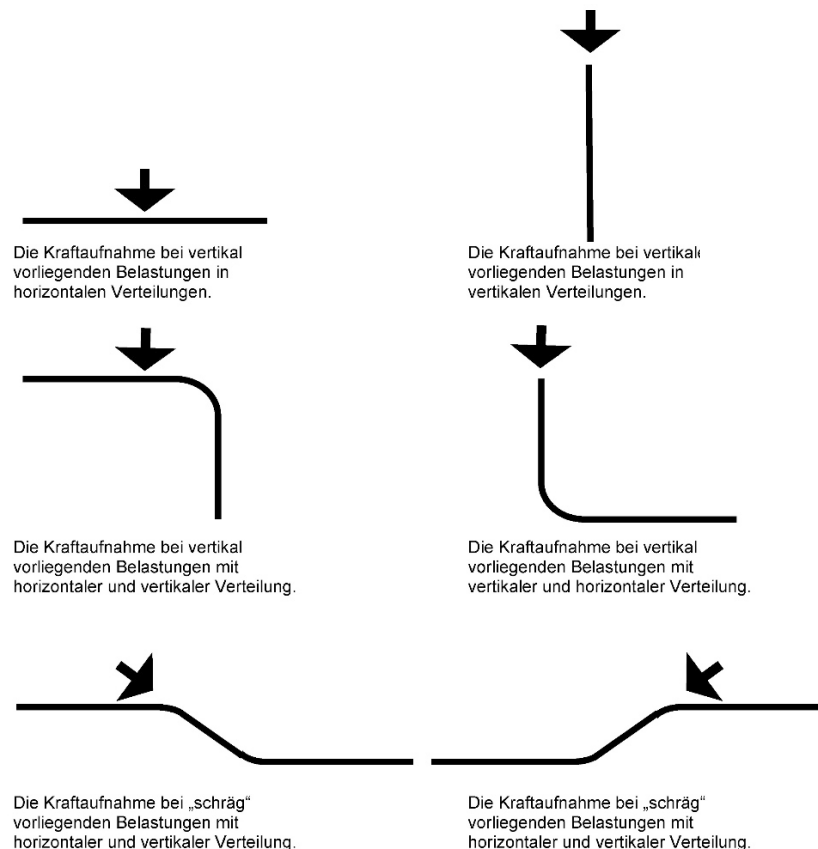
Die Mindestbetonstahlpositionen und -biegeformen zur Kraftaufnahme
